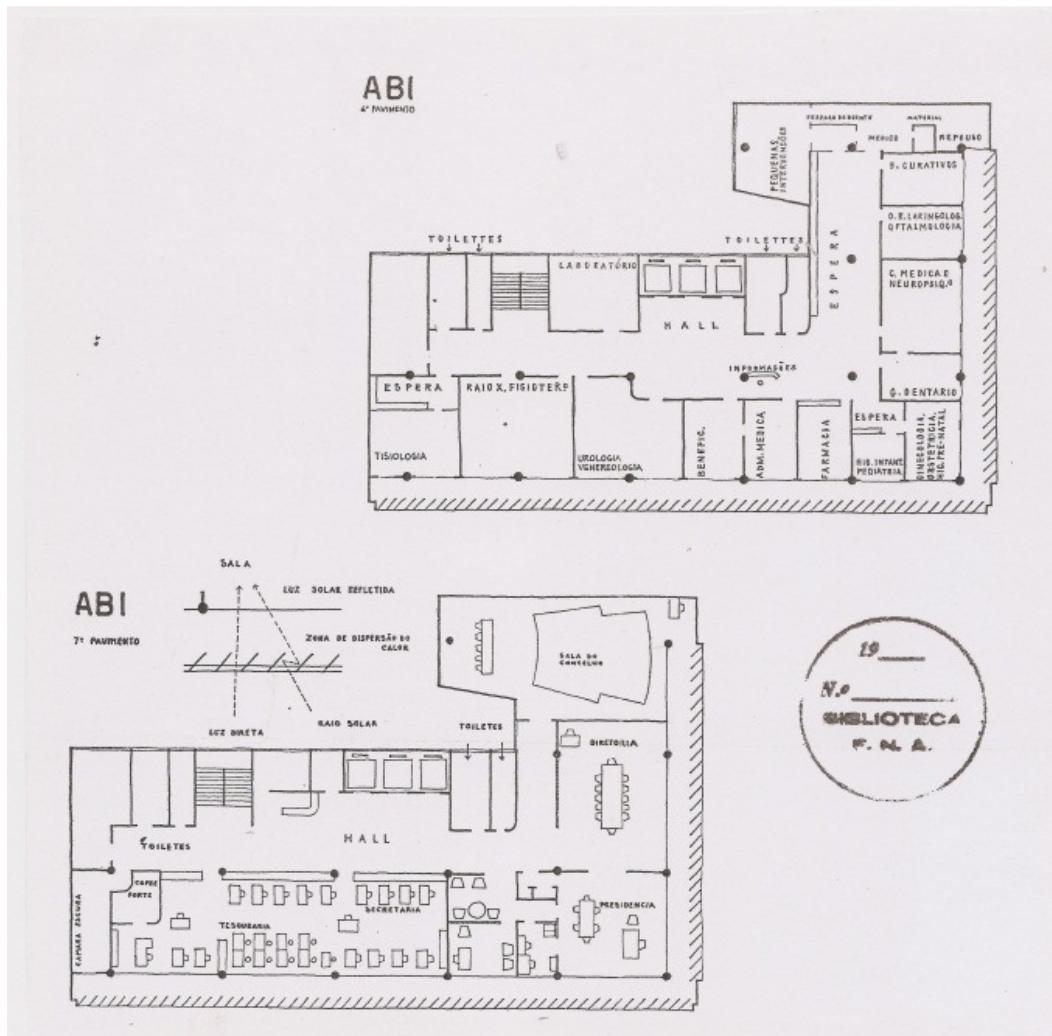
G – Plantas baixas do sexto pavimento (setor médico) e sétimo pavimento
